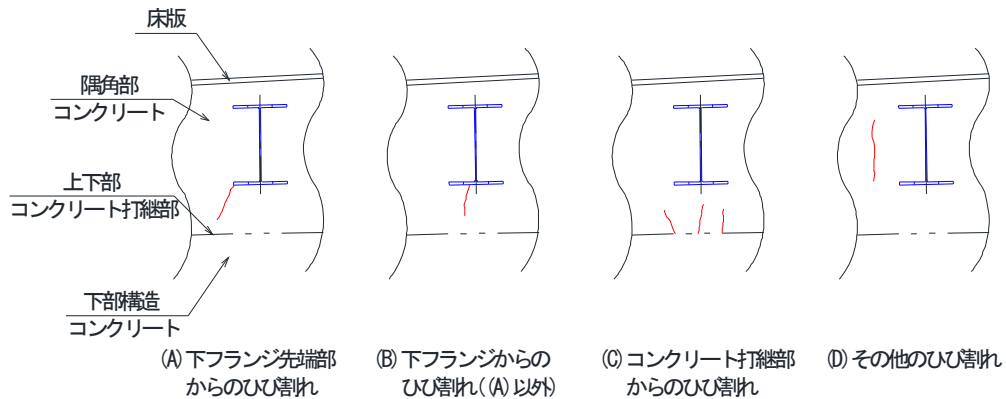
橋台たて壁部のひび割れパターン
